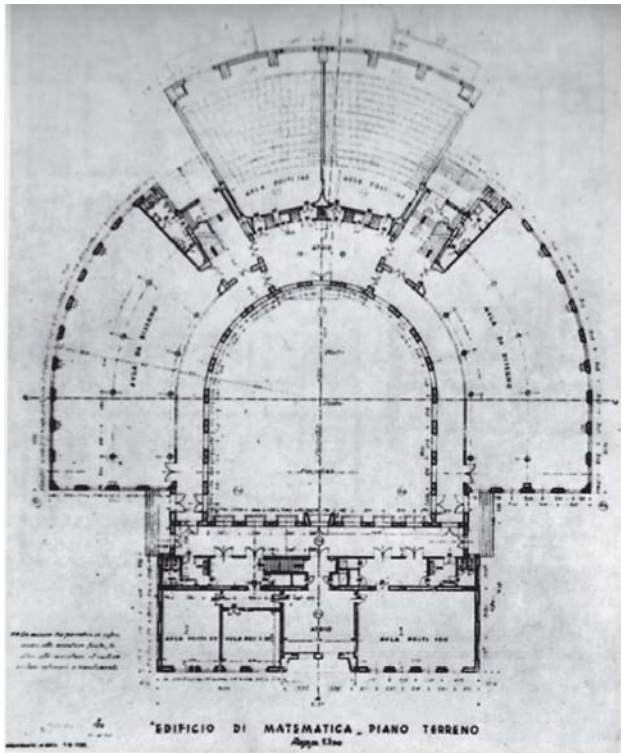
Planta do pavimento térreo (ASSUR, Patrimônio Edilício, 1935).
